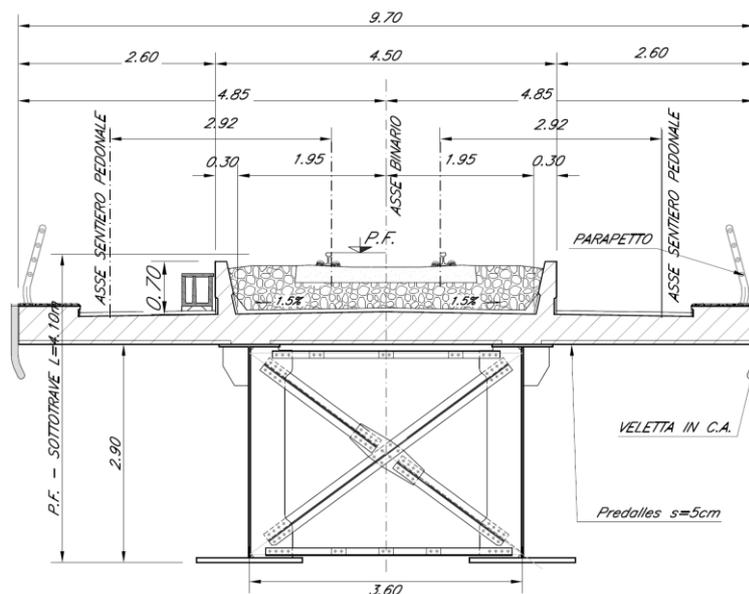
Sezione trasversale campate in acciaio-clc L=40 m
